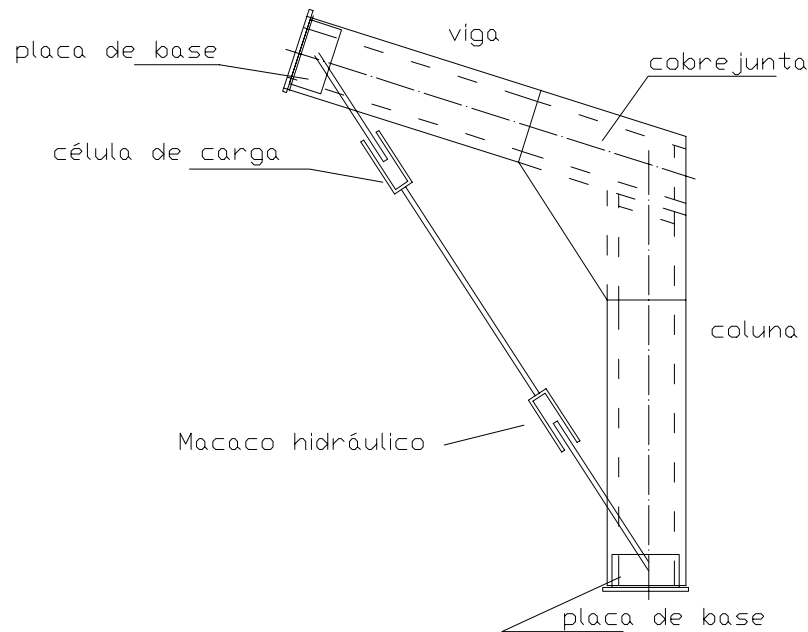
Arranjo de ensaio de nó de pórtico. Fonte: MILNER&WOODARD (1995)
